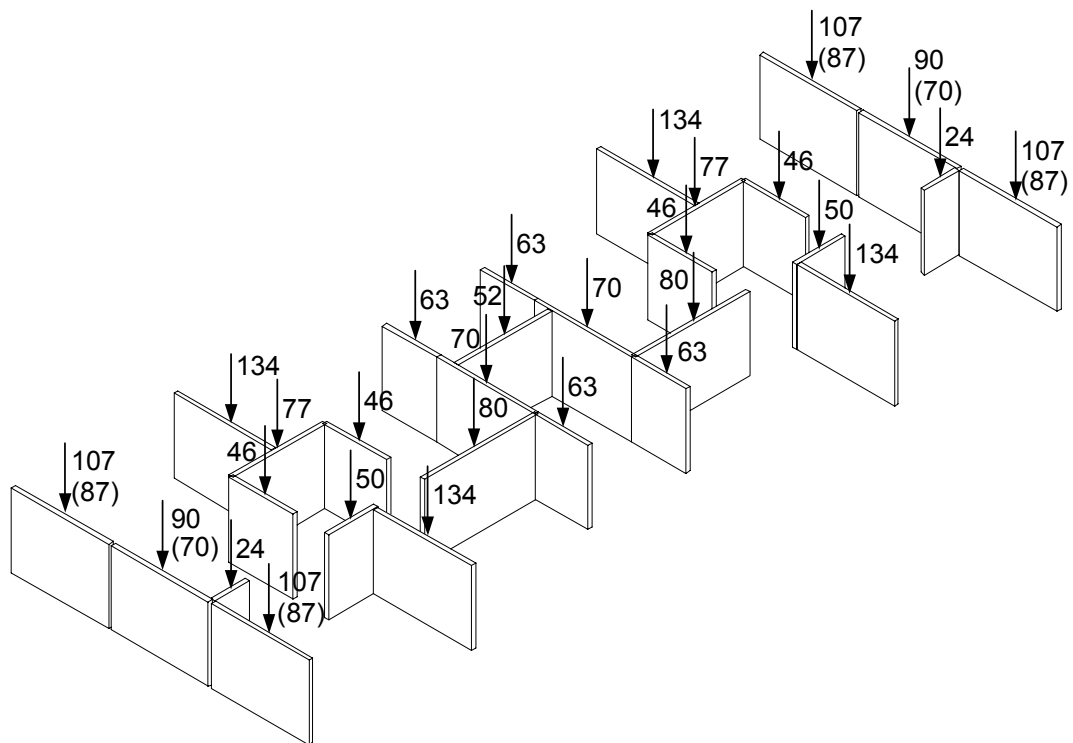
Vertikallasten für ein Vollgeschoss [kN]
